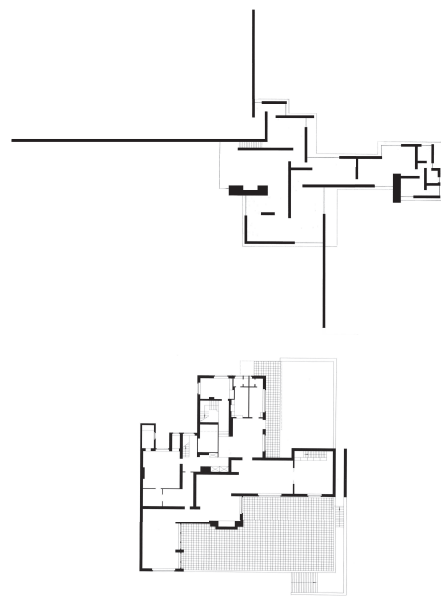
A gauche, plan de la maison de campagne en briques. A droite, plan de la villa Wolf. On
